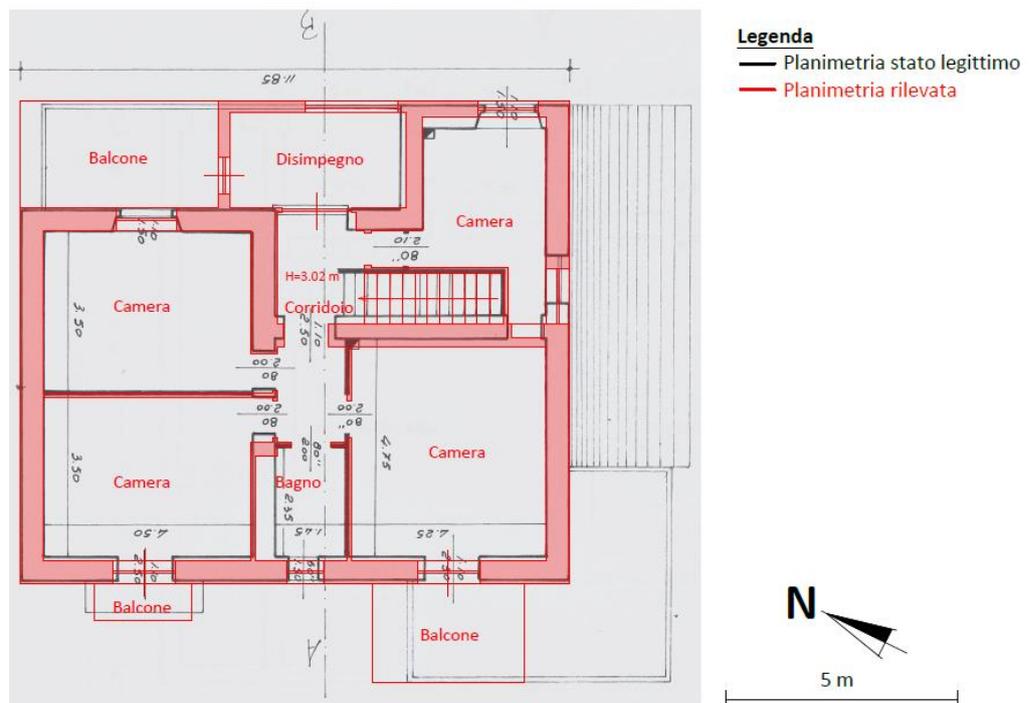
Sovrapposizione stato reale dei luoghi e progetto autorizzato – Planimetria piano 1° del fabbricato principale (F. 20 p.IIa 202)
